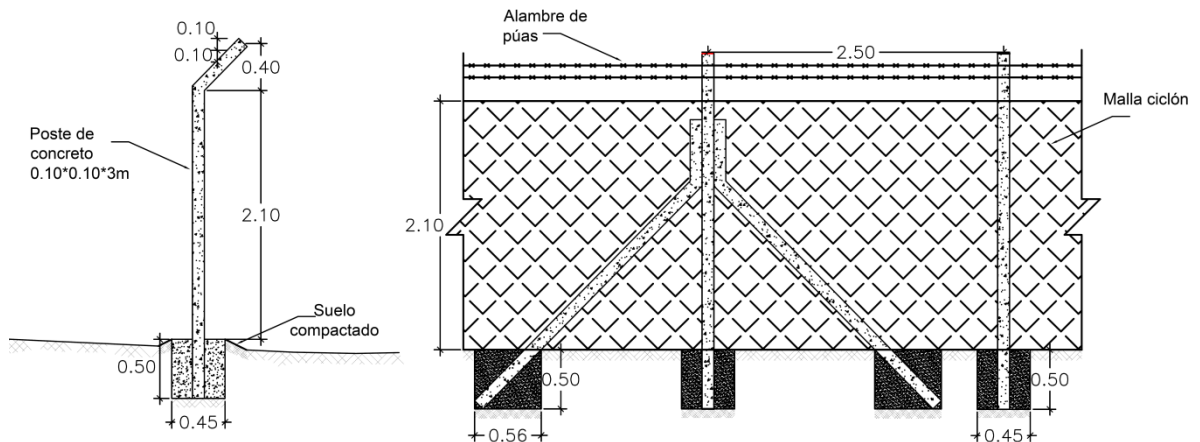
Detalle del cerco perimetral, sin escala.
